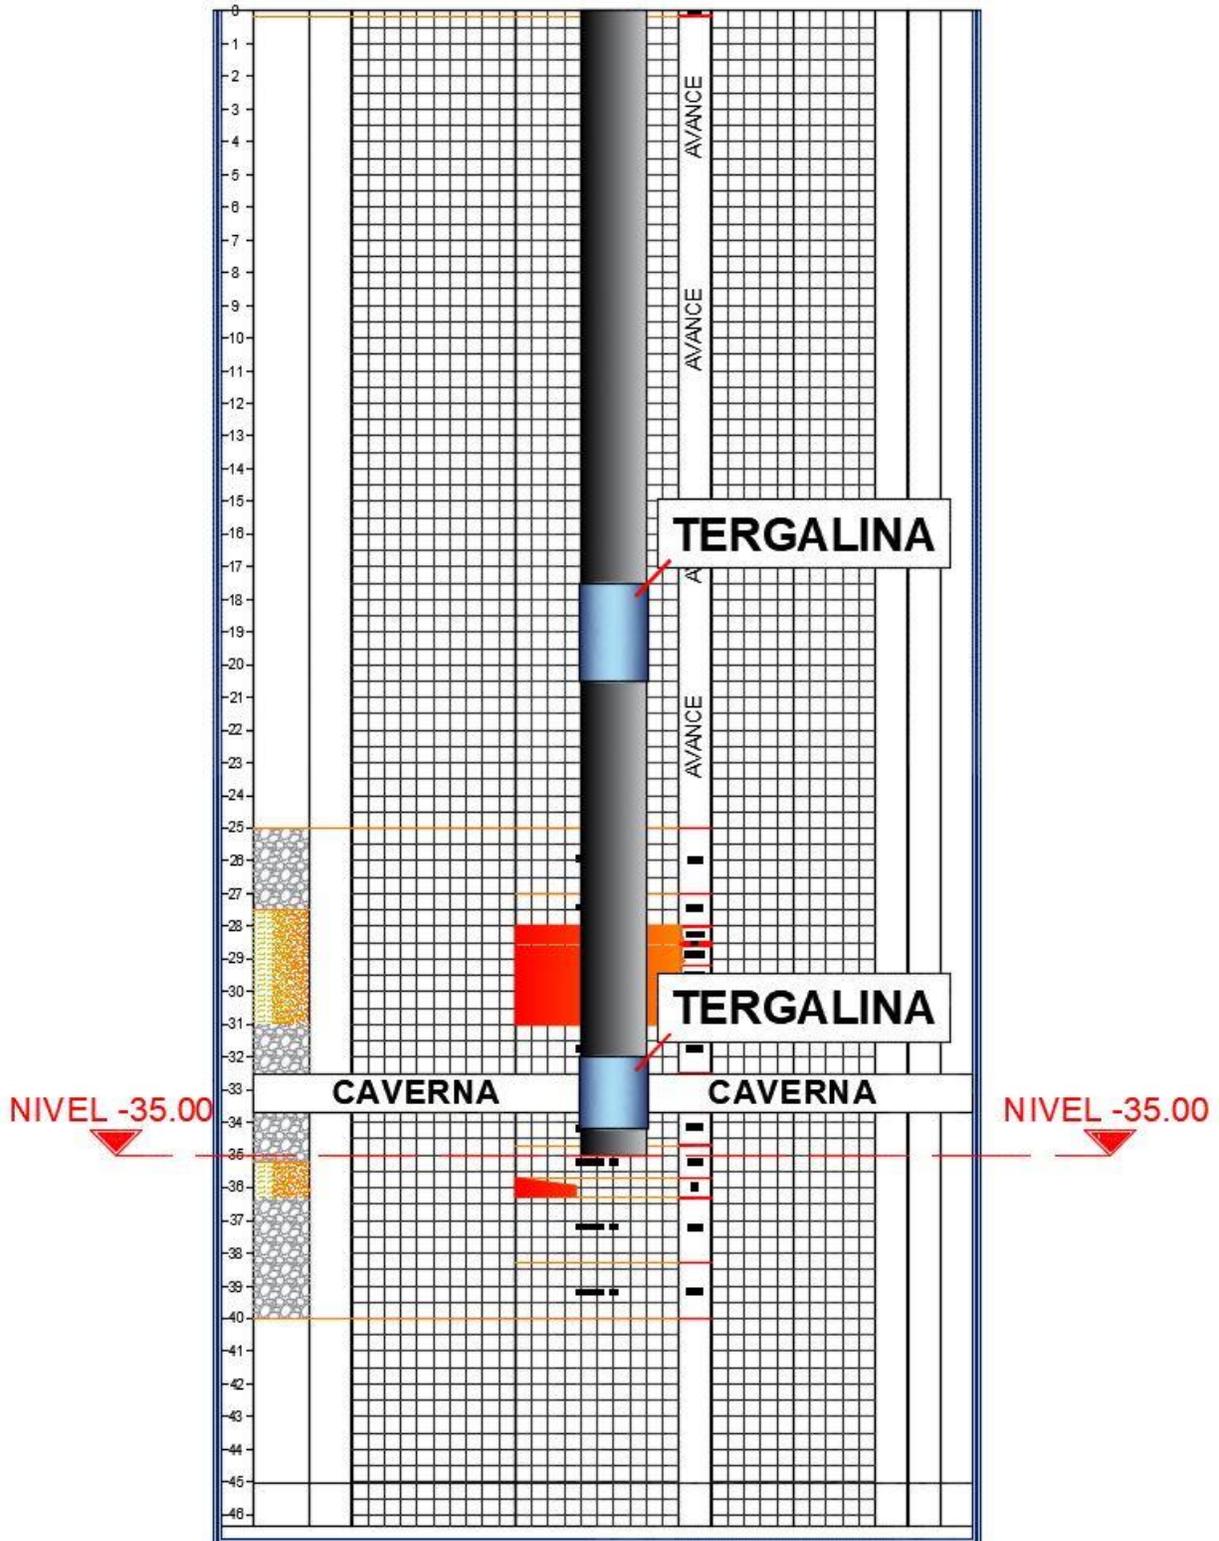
PILA 14 (SM-14 EJE D6).
